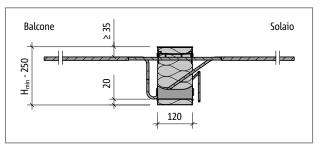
Schöck Isokorb® tipo KXT55 – KXT100: sezione dell'elemento
